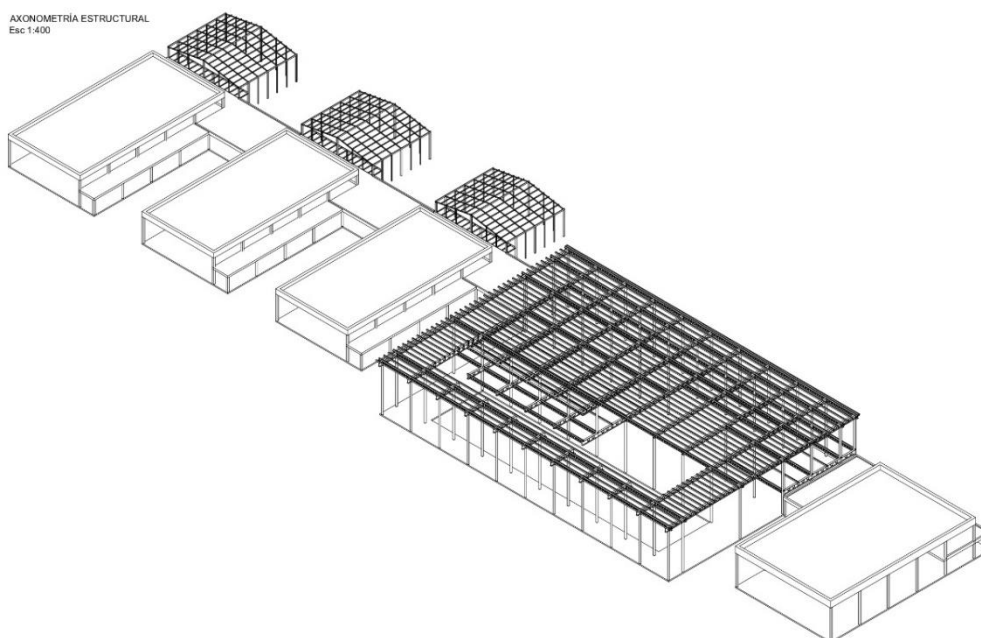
Axonometría estructural del proyecto “Instituto Técnico Despeñaderos”.
